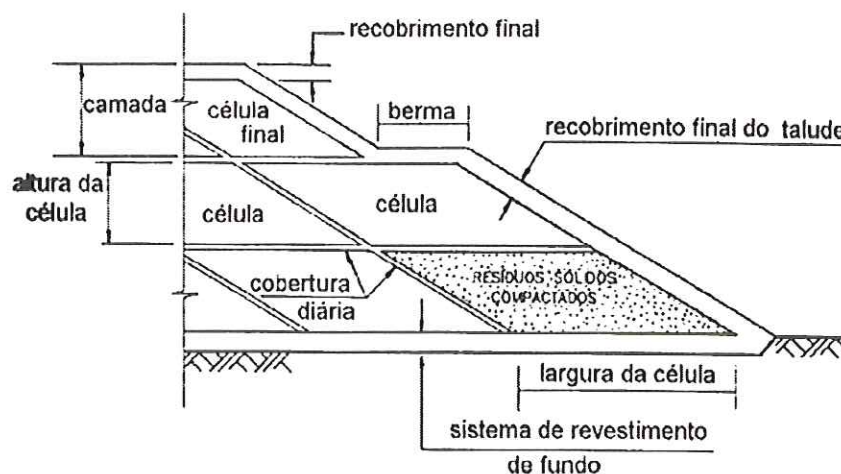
Estrutura de um aterro sanitário (ENGEORPS, 1996).
